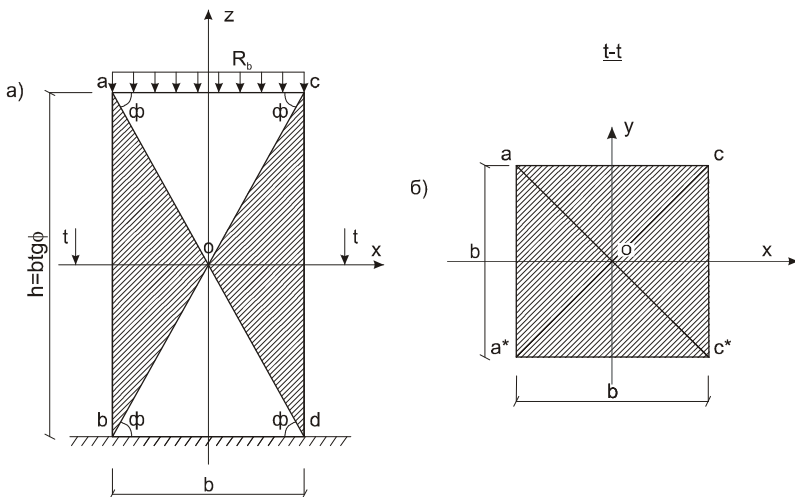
Схема разрушения бетонной призмы при осевом сжатии:
